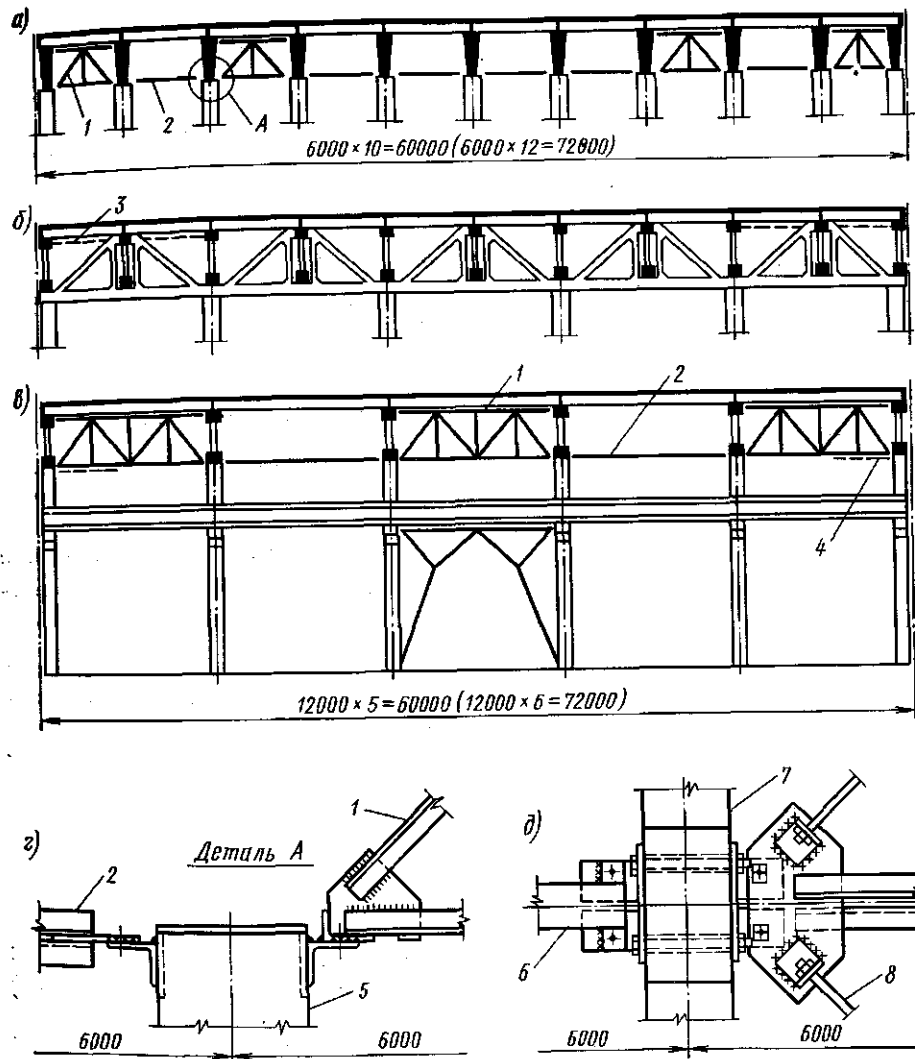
Связи в покрытиях при железобетонных фермах:
